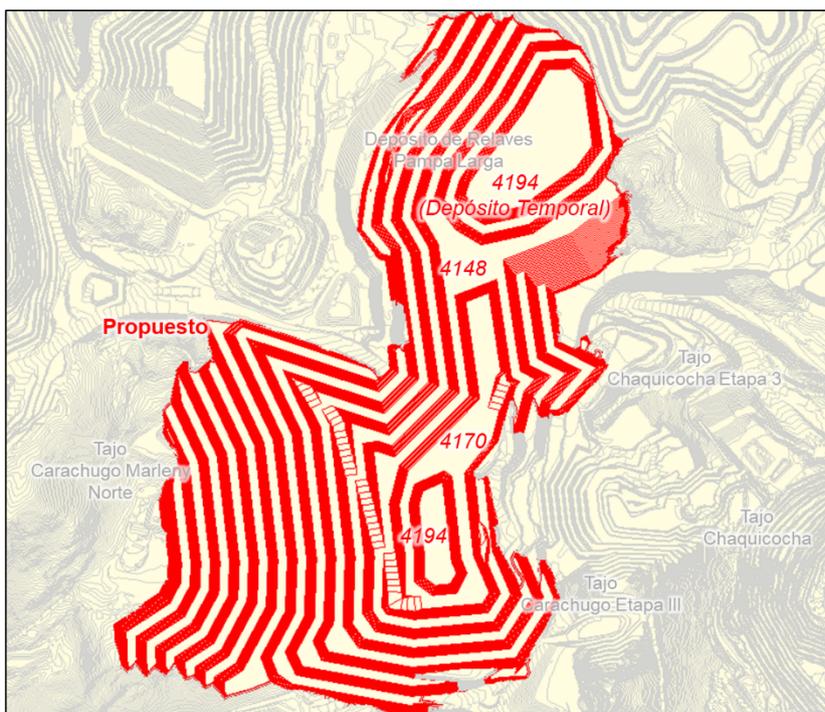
Plan de descarga del Relleno Carachugo Etapa 3 – Año 2022 – Vista en planta
